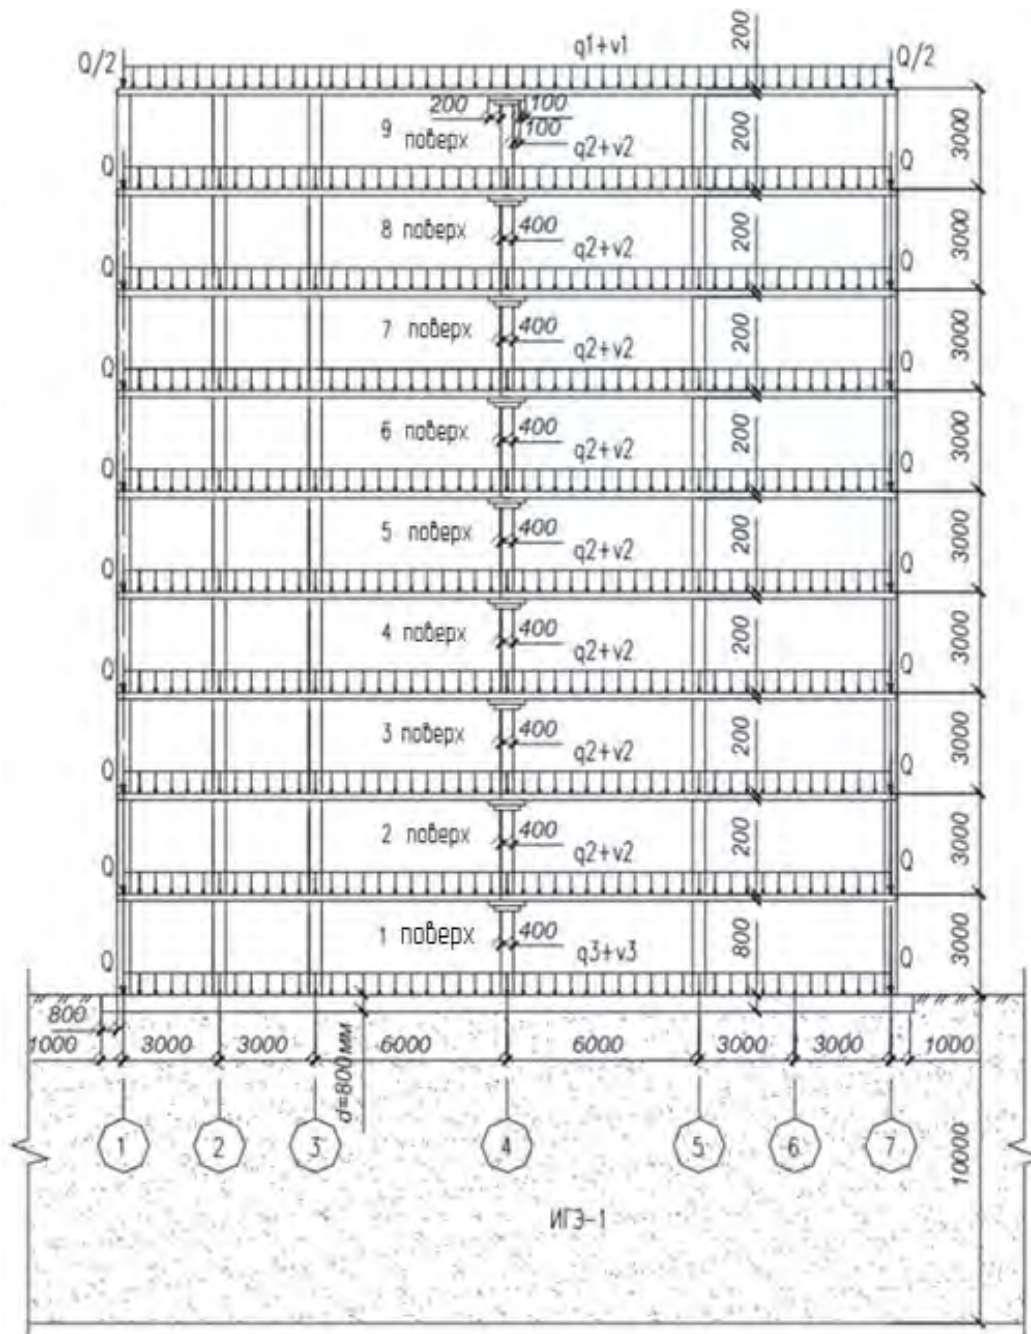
Розрахункова схема будівлі (розріз А-А)
